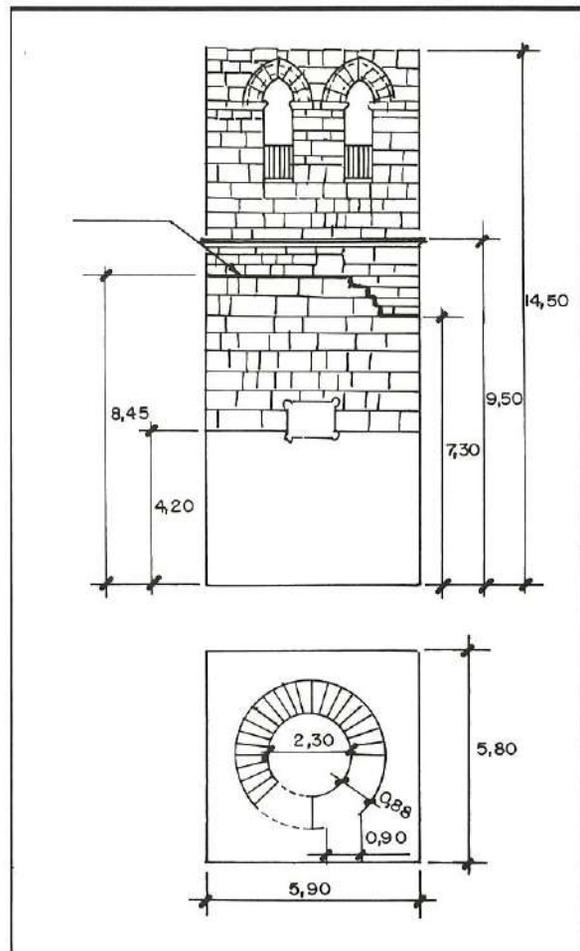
Planta y alzado por su frente norte de la torre de la iglesia de El Salvador (Torres Balbás, 1946).
